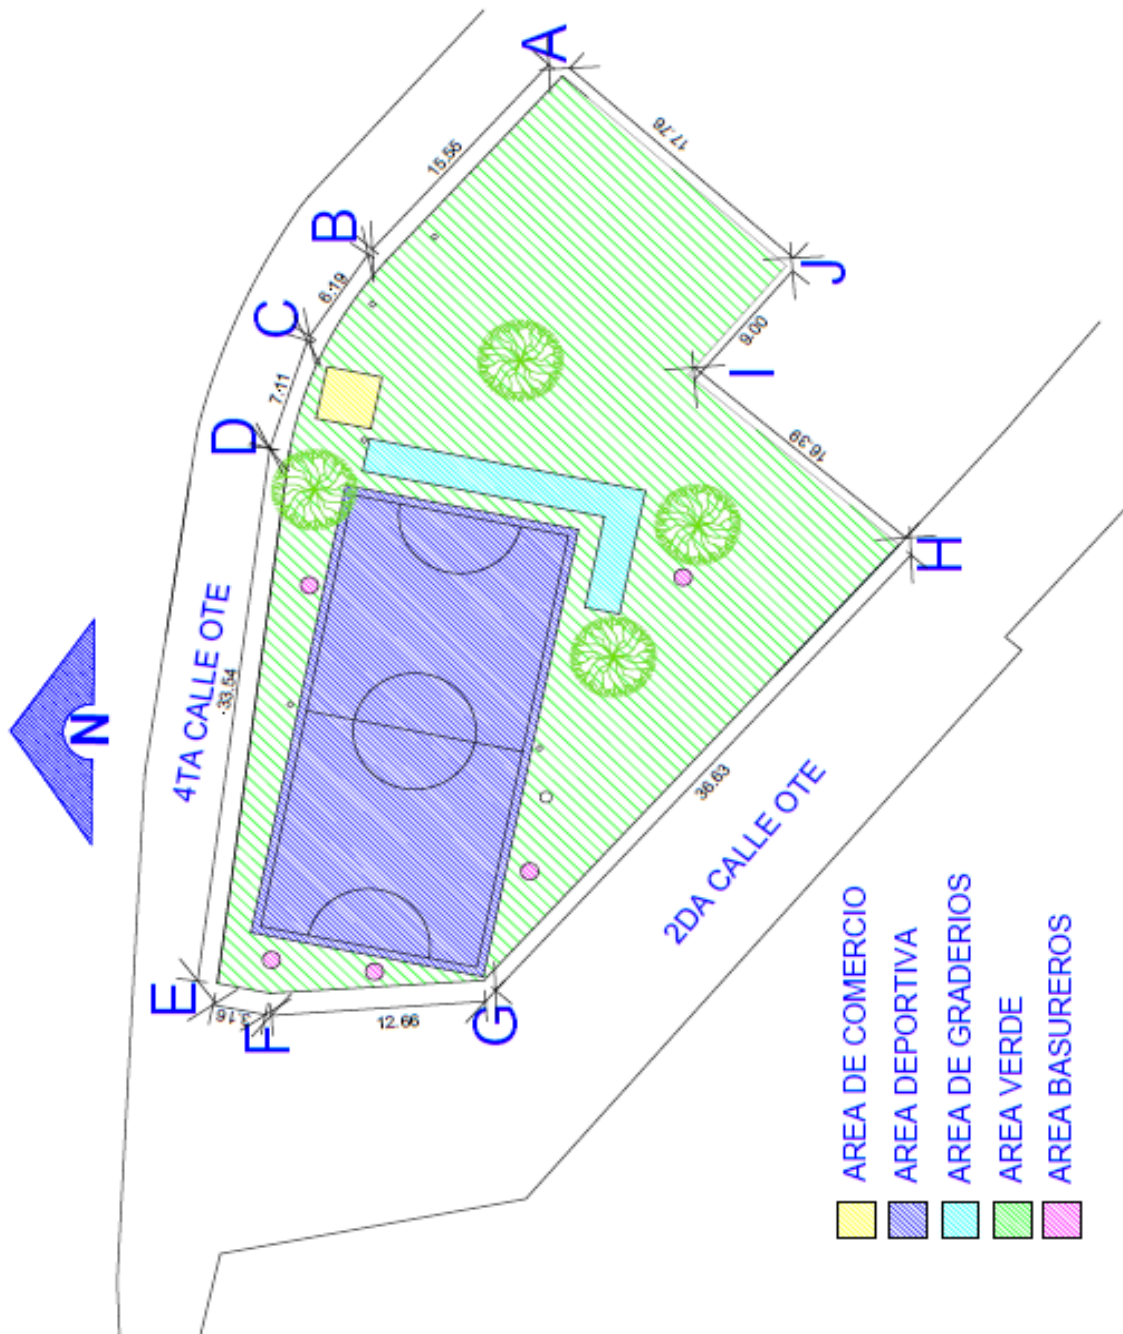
Planta arquitectónica actual. Fuente: Propia.
